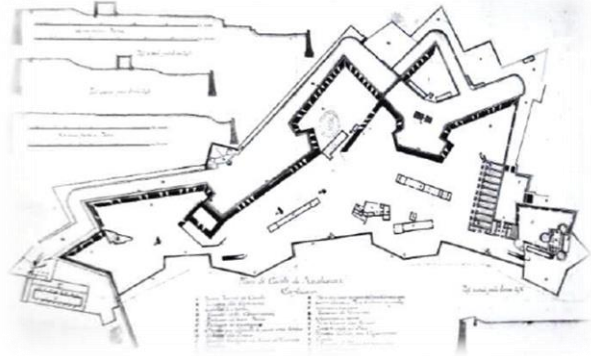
plan du château neuf (Rosalcazar) 1791
